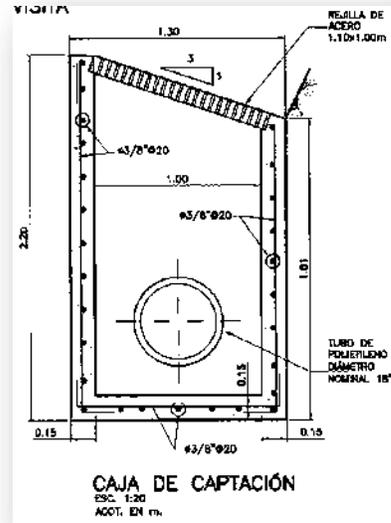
Caja de captación. Fuente (Proyecto ejecutivo).
